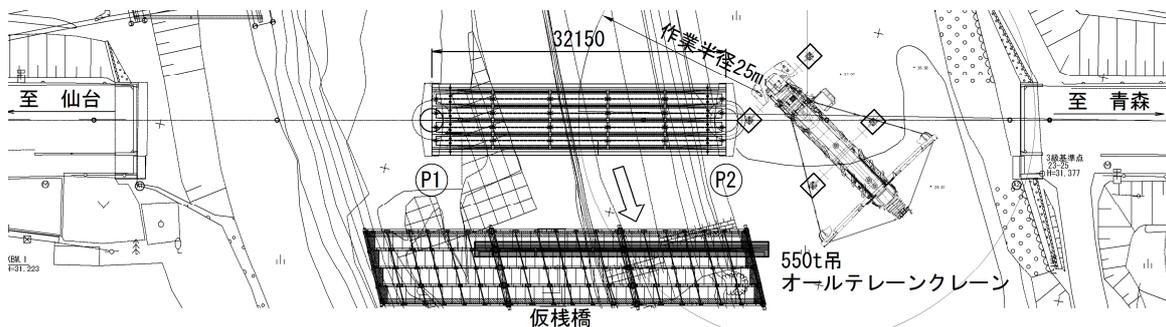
上部工撤去要領図（見直し計画：側径間撤去後の平面図）
